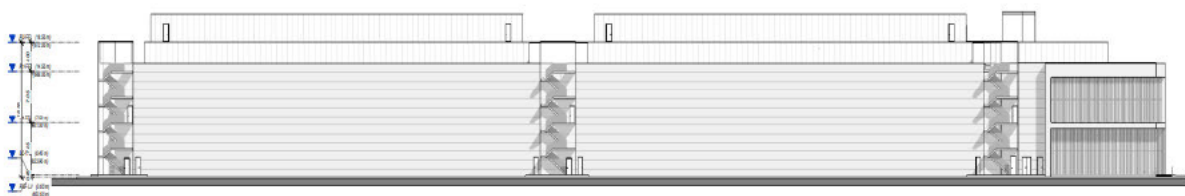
SOUTH EAST ELEVATION - Alzado Sureste.
